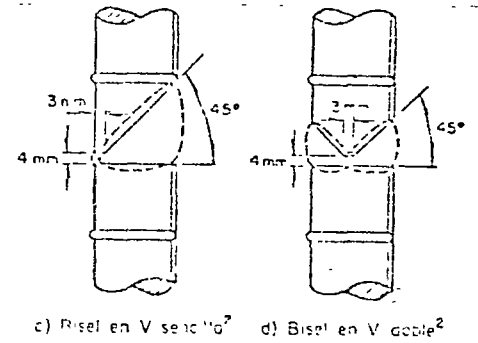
UNIONES REFORZADAS CON ELEMENTOS DE RESPALDO
